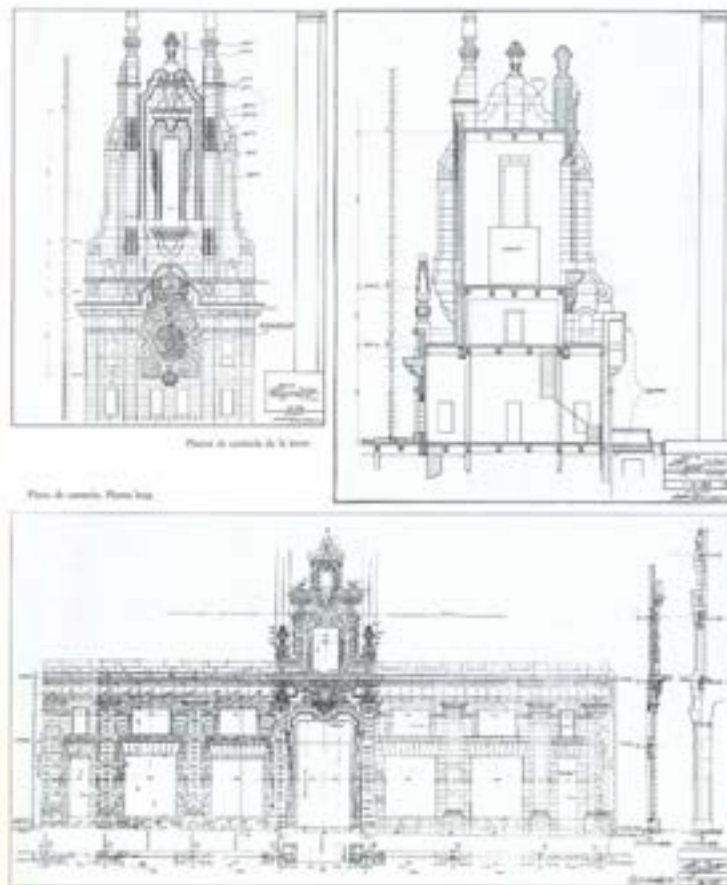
Fuente: P. Navascues (1984). Detalles de cantería del proyecto original de Ignacio Cárdenas.
